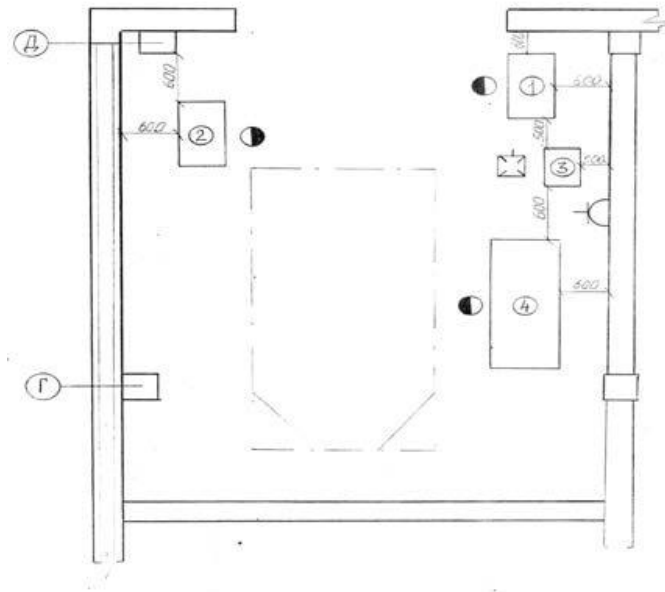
Планировка кузовного участка: 1 – стол для газосварочных работ 7574; 2 – стеллаж для радиаторов и бензобаков 5121; 3 – трансформатор сварочный однопостовой СТШ-300; 4 – верстак для кузовных и жестяницких работ.
